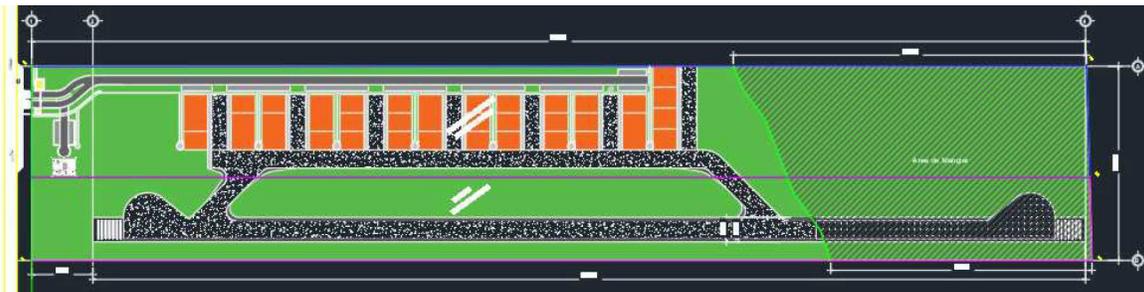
Plano general de obra del proyecto (infraestructura). Se observa la distribución de la pista y área de rodamiento, los lotes residenciales, vialidades, etc.
